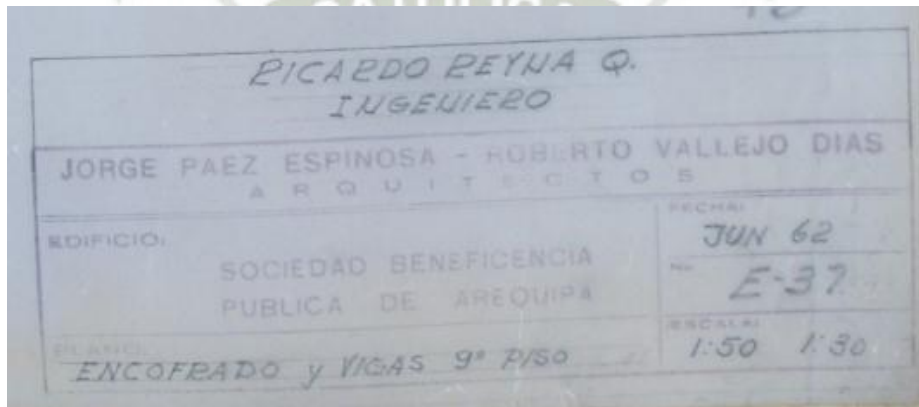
RÓTULO PLANO ESTRUCTURAS
